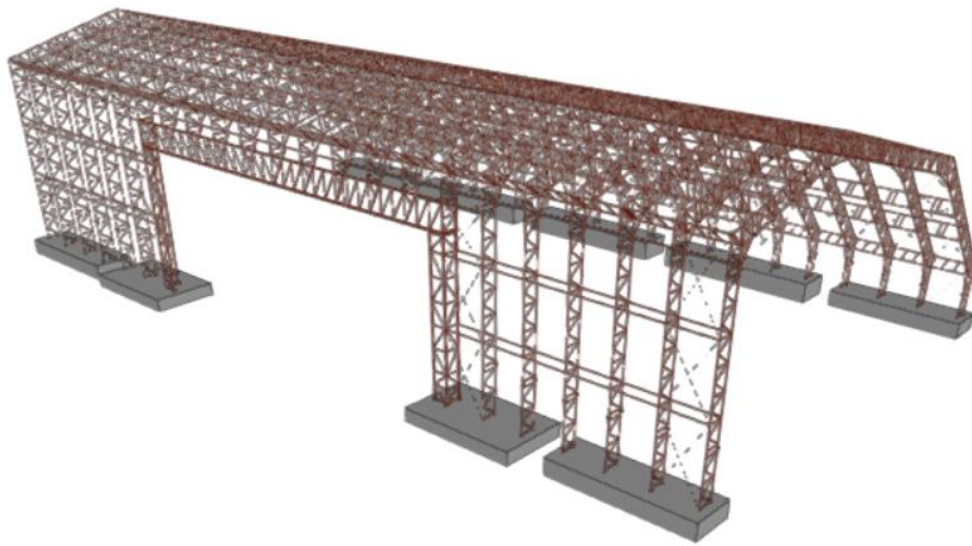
Perspectiva de la estructura metálica. Fuente: CYPE 3D
